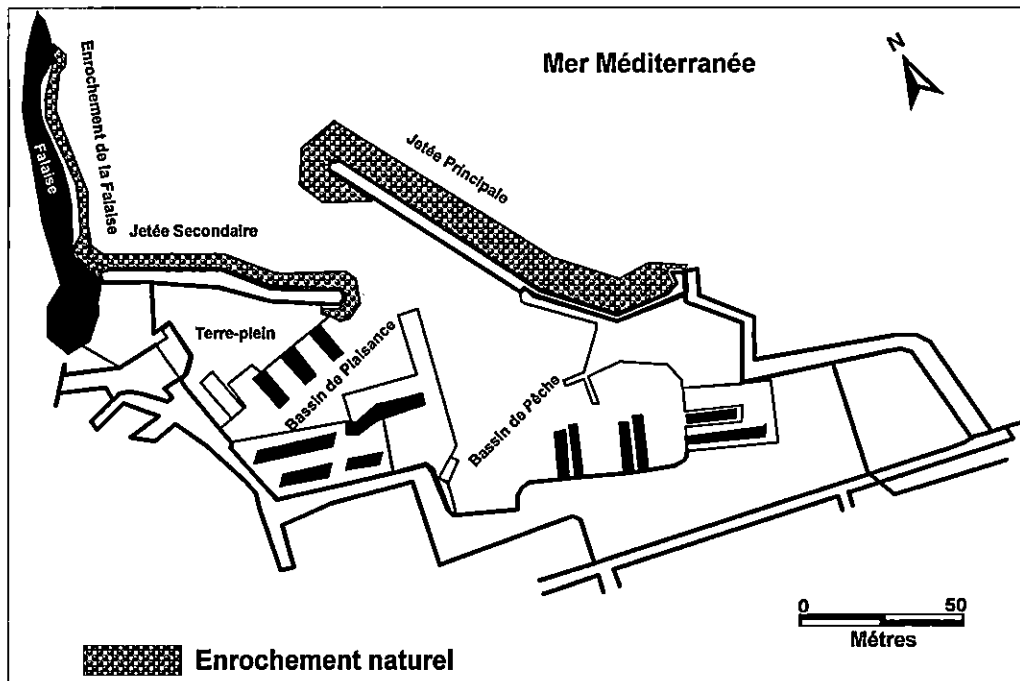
Schéma général du nouveau port de Tipaza. (DTP de Tipaza, 2007)
